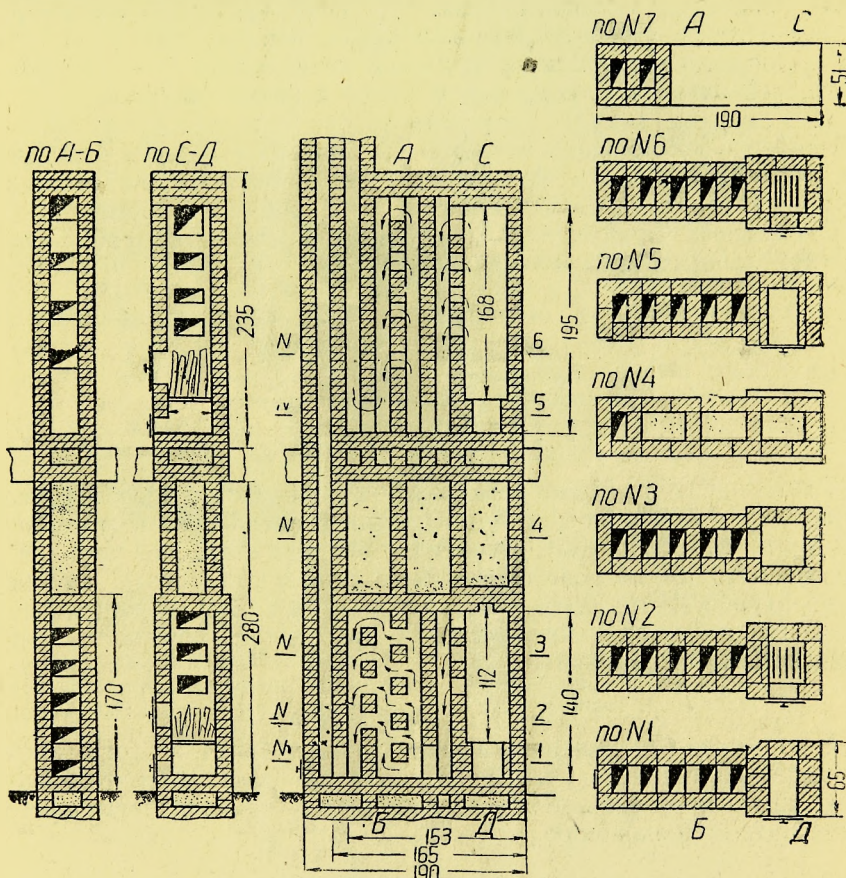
Двухъярусная печь (мелкоколпаковая) плоской конструкции для барачков на 2300—2100 калорий.
